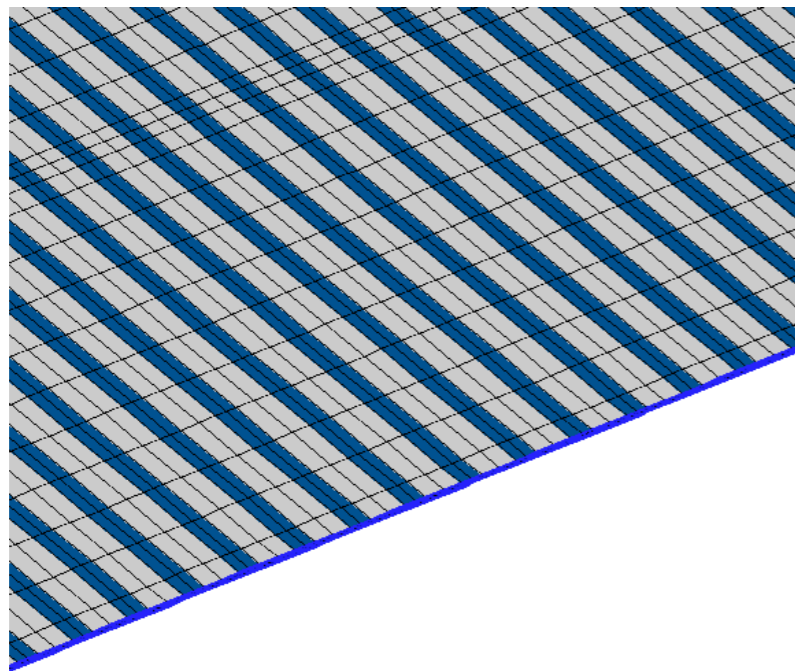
Фрагмент расчетной схемы опирания перекрытия с профилированным настилом на стальную балку
